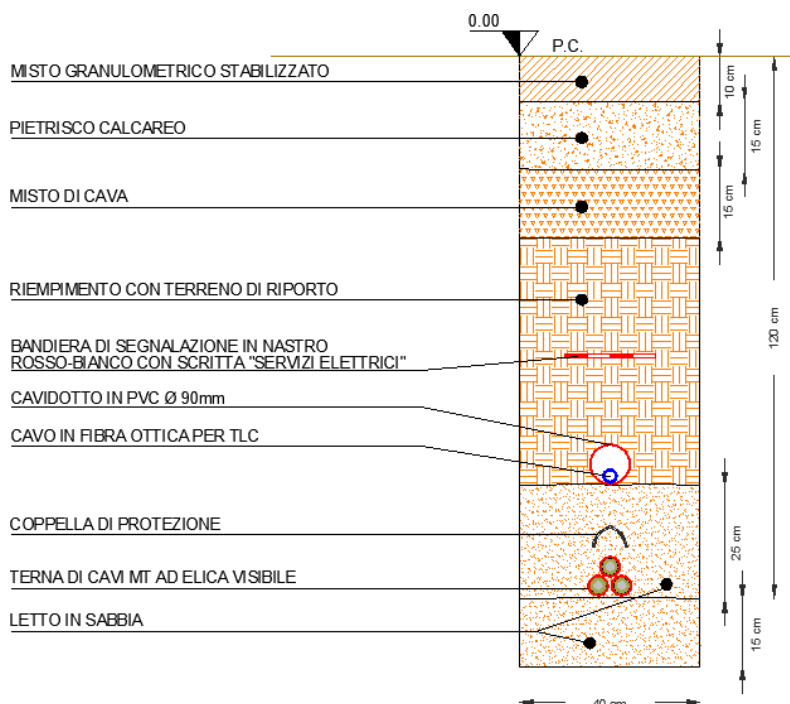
Sezione tipo di scavo per la posa del cavidotto su strada esistente
